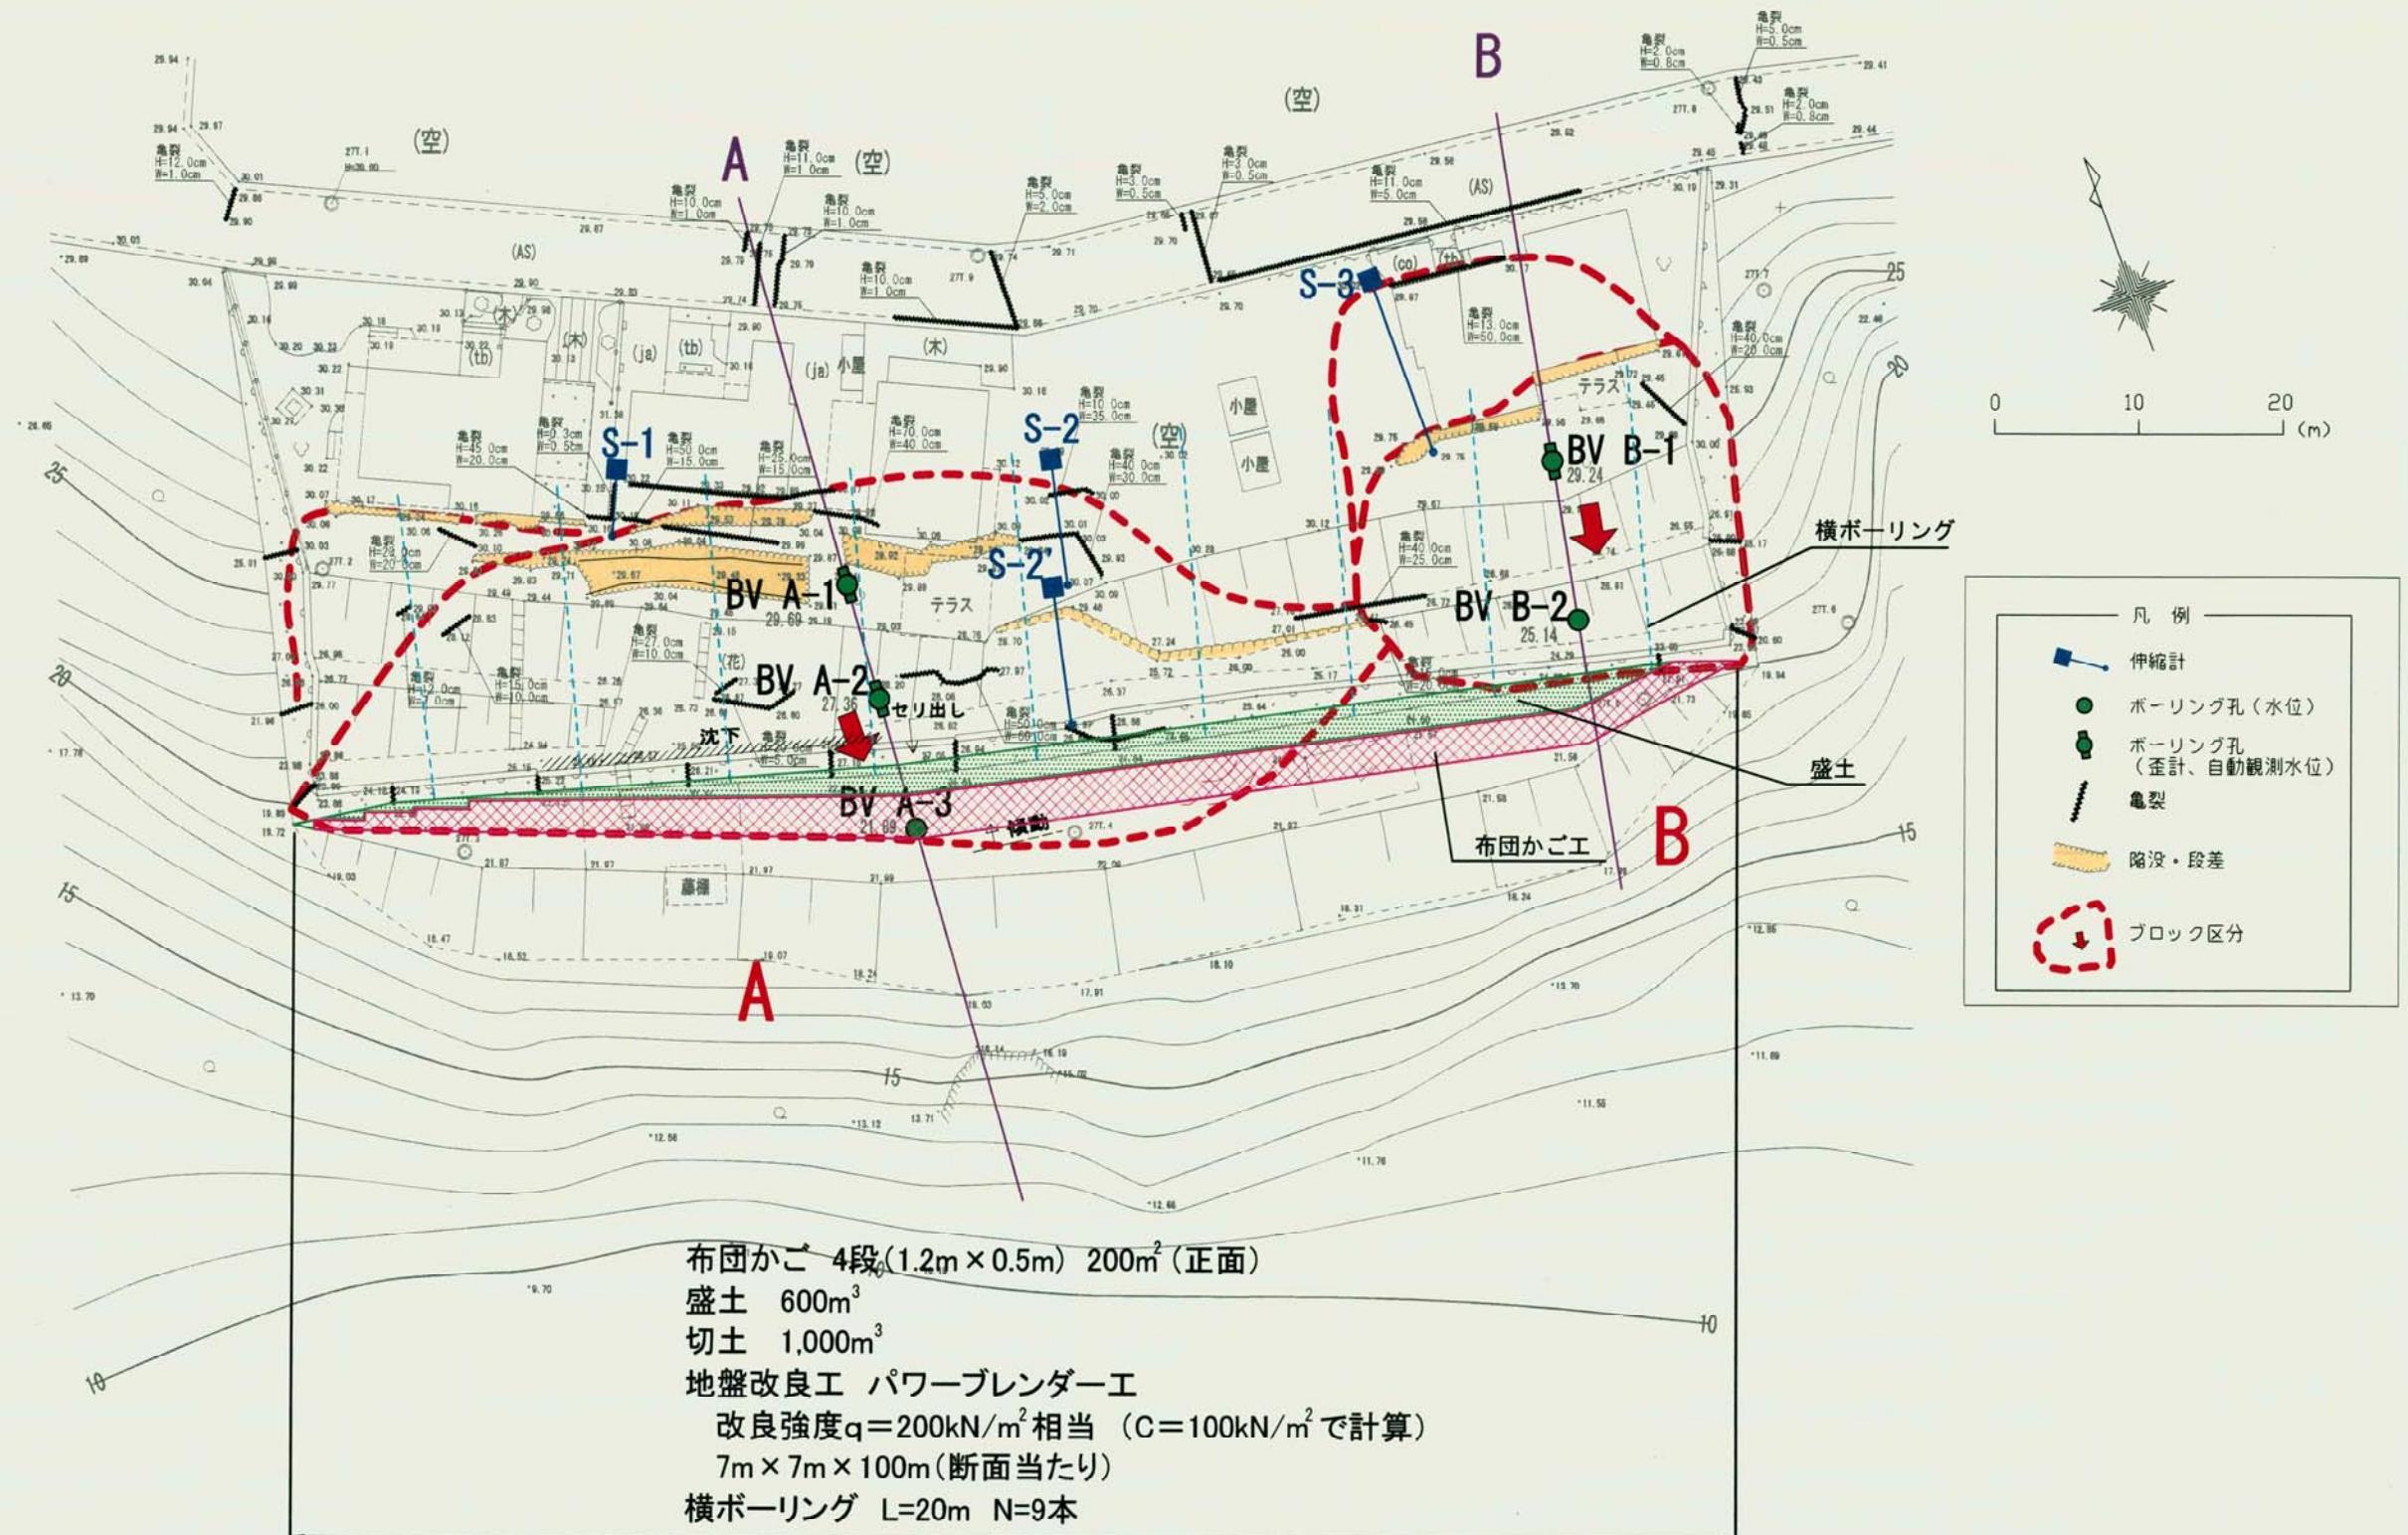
第3案：盛土工（ふとん籠工）+地盤改良工 平面図
